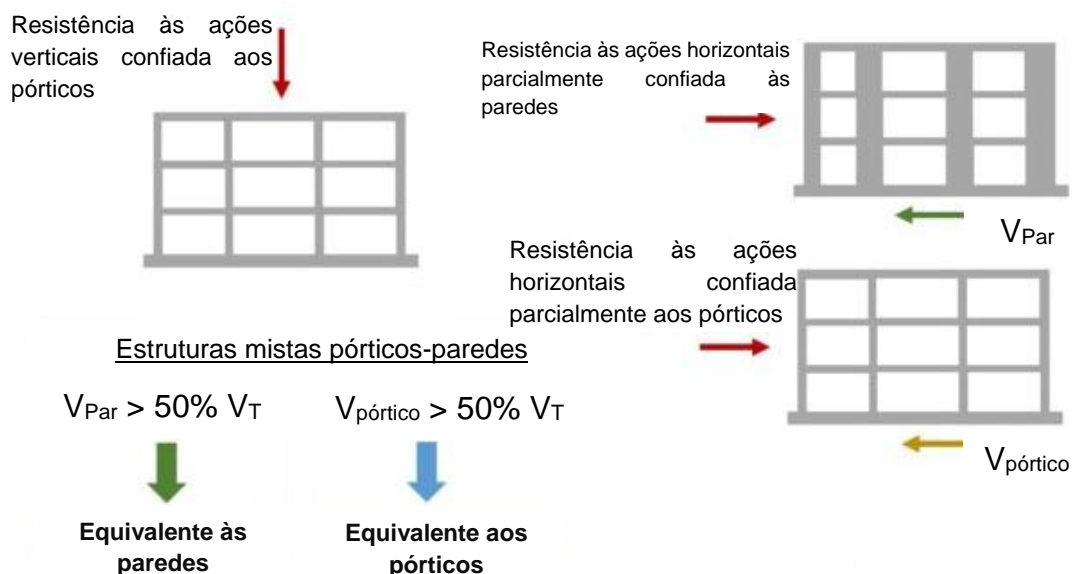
Estruturas mistas pórtico - parede resistente
